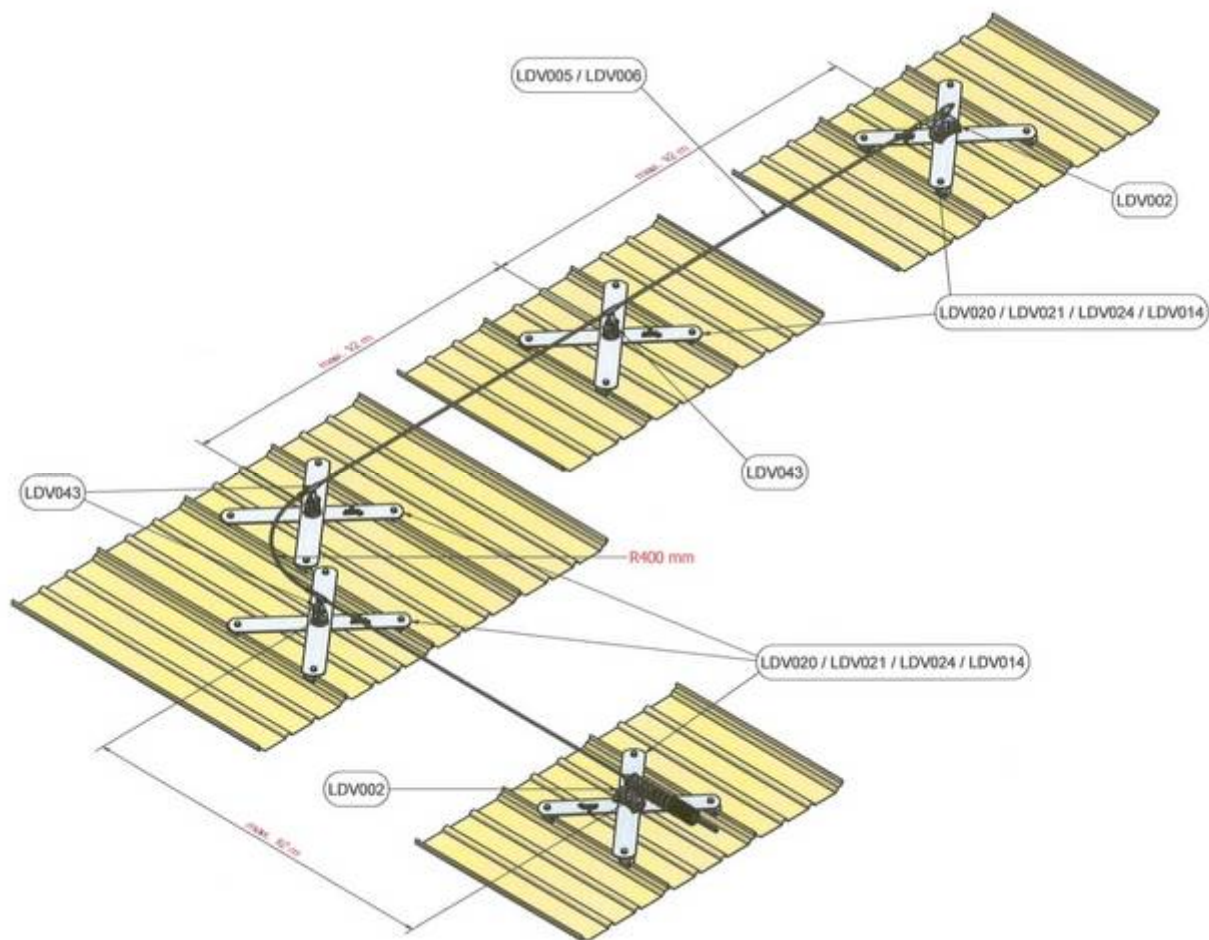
Configuration type : Ligne de vie Securope toiture à joints debout
